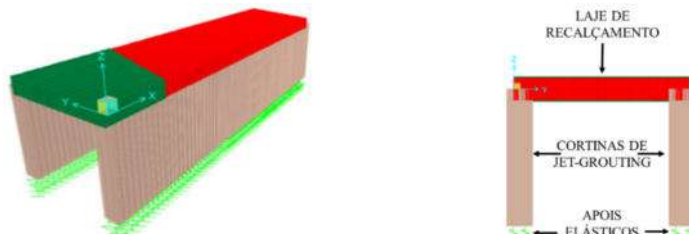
Modelo de análise SAP2000 para a laje de recalçamento.
